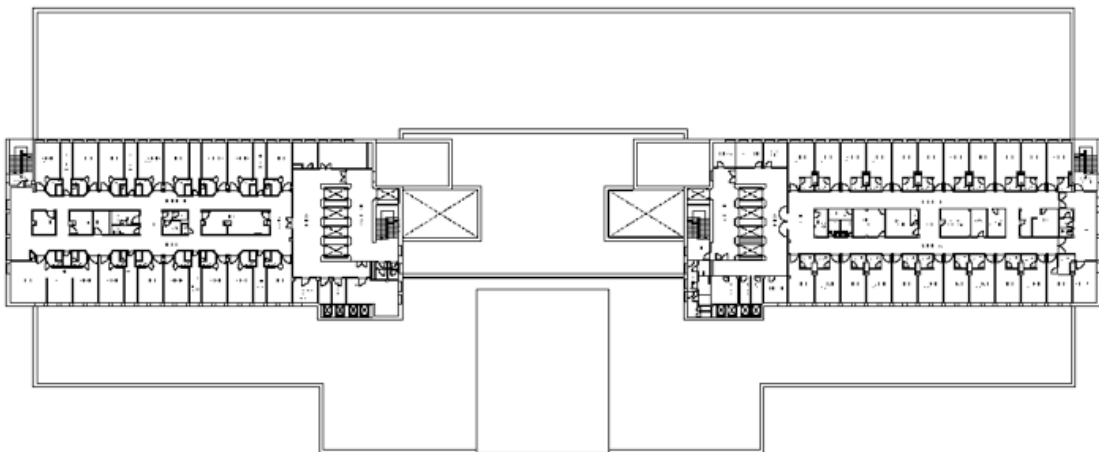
Plano de la planta baja del Pabellón A del H. General donde se aprecia su planta rectangular.
